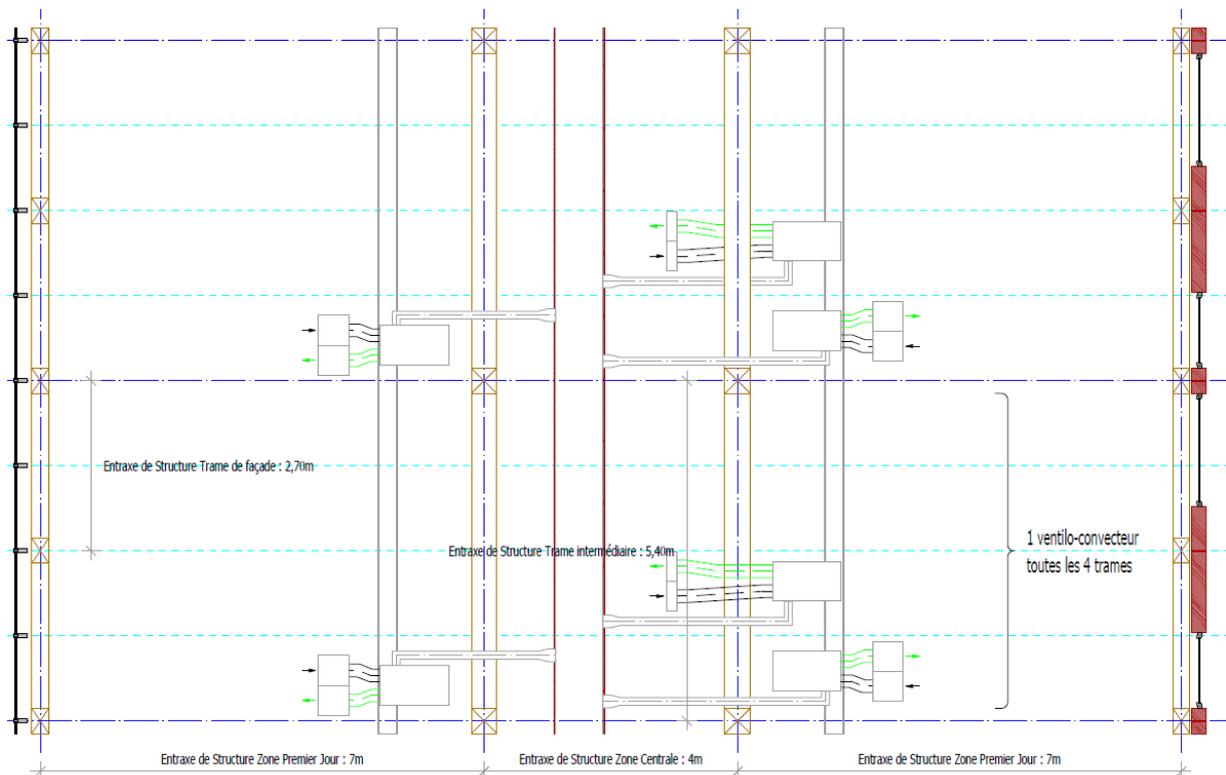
Vue en plan d'un niveau du bâtiment projet
